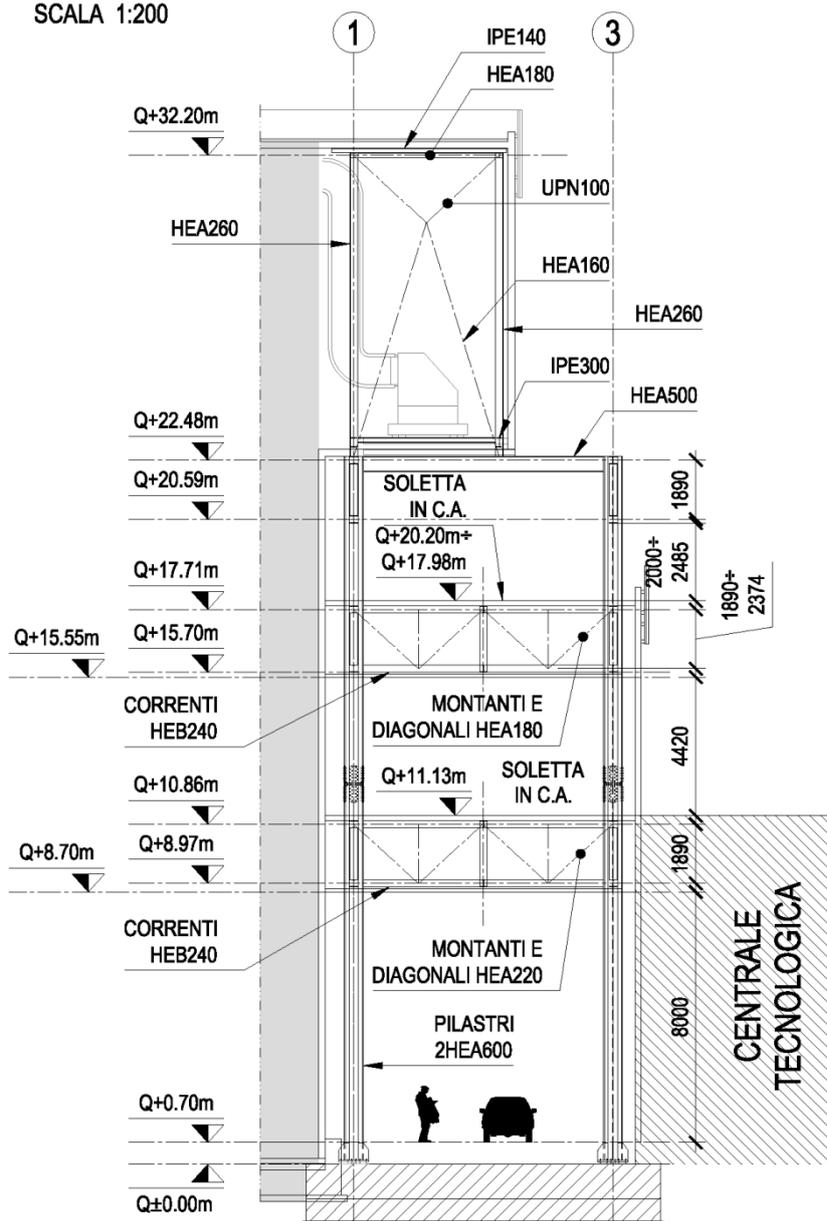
Sezione trasversale tipo struttura di elevazione
